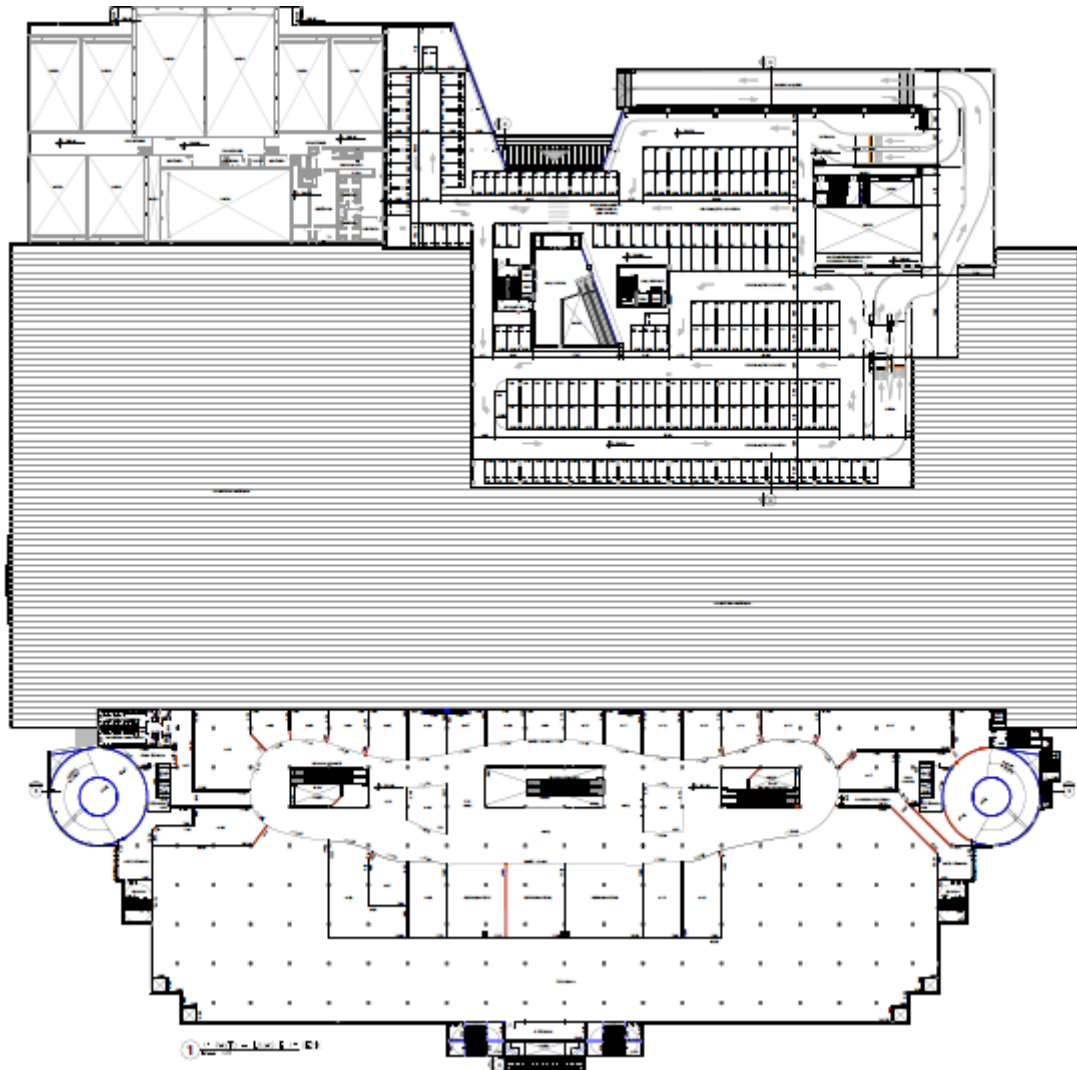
Planta Primeiro Pavimento - Lojas e 1º Deck. Fonte: Engexpor.
